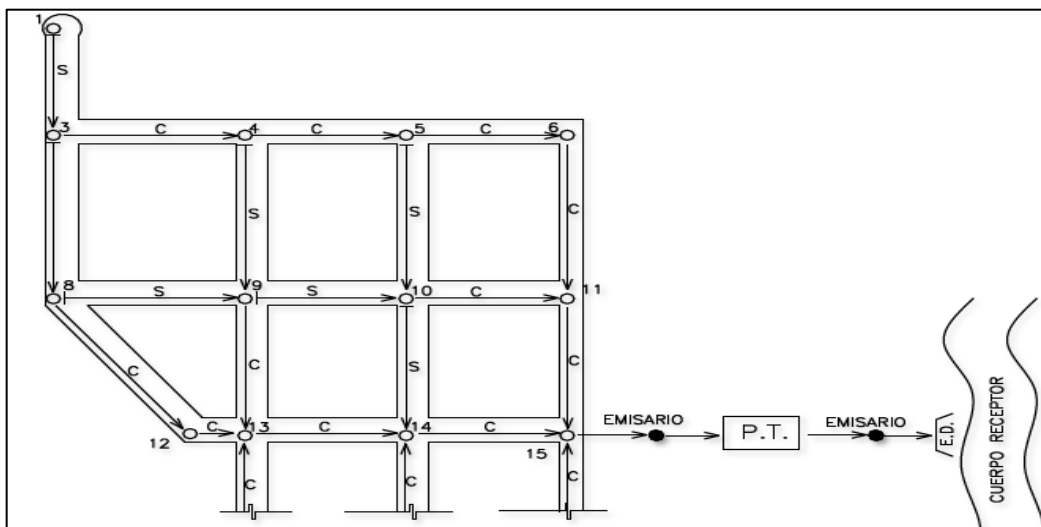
Partes constitutivas del sistema de alcantarillado sanitario.
